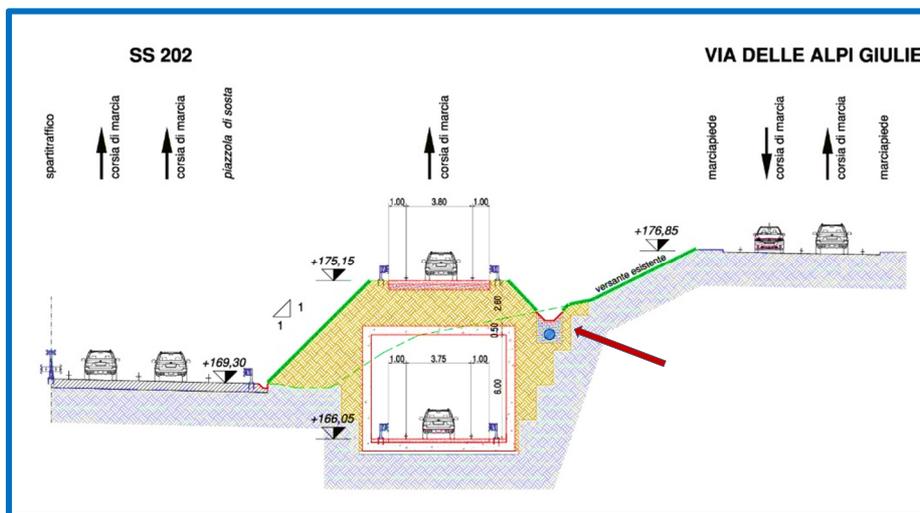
Nella sezione del progetto della strada dell'ing. Novarin alla base del rilevato in terre armate è presente sia una cunetta sia un tubo drenante (vedi freccia rossa).
